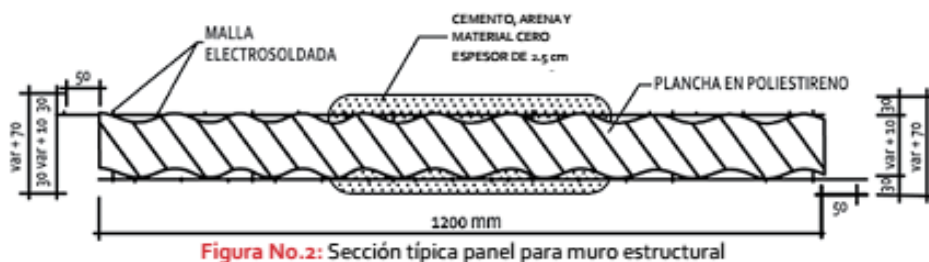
Sistema Constructivo EMMEDUE – Hormi2 Perú para Viviendas Sociales. Vista en corte de los componentes de un panel prefabricado [28].
